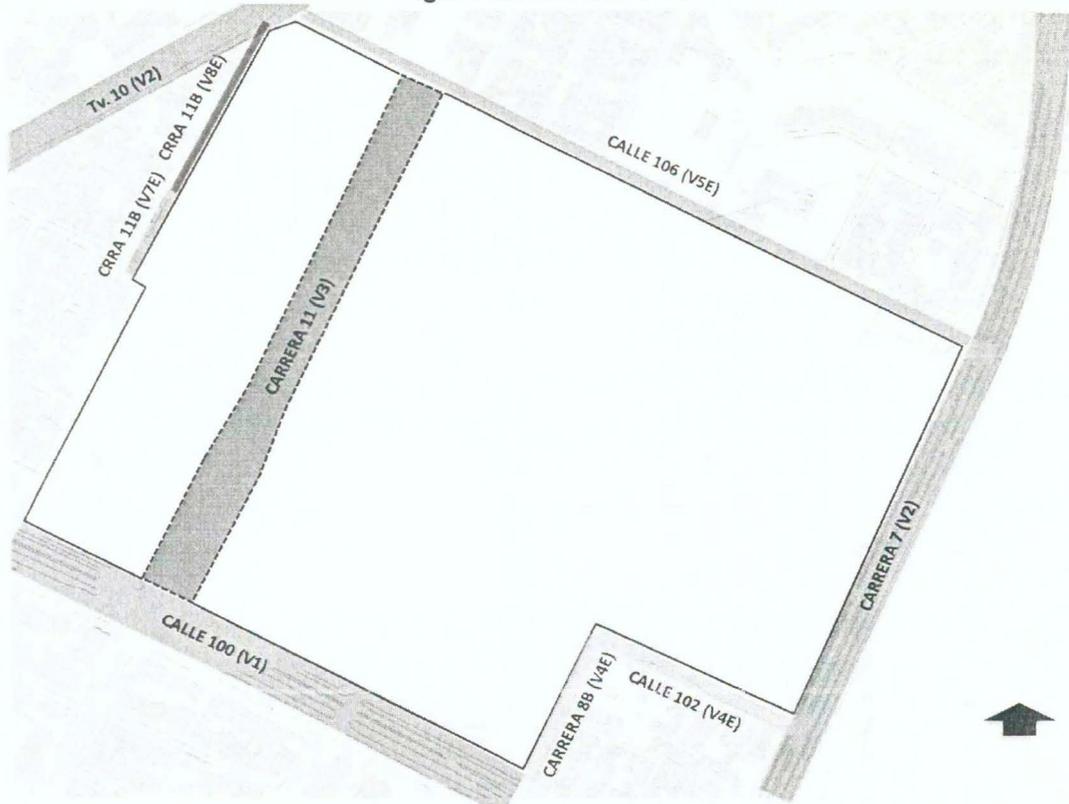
Perfil Vial Avenida Germán Arciniegas (Carrera 11).
